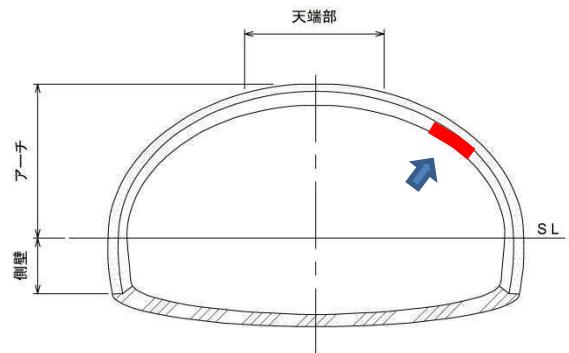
色むら・打重ね線に沿って発生したひび割れ
